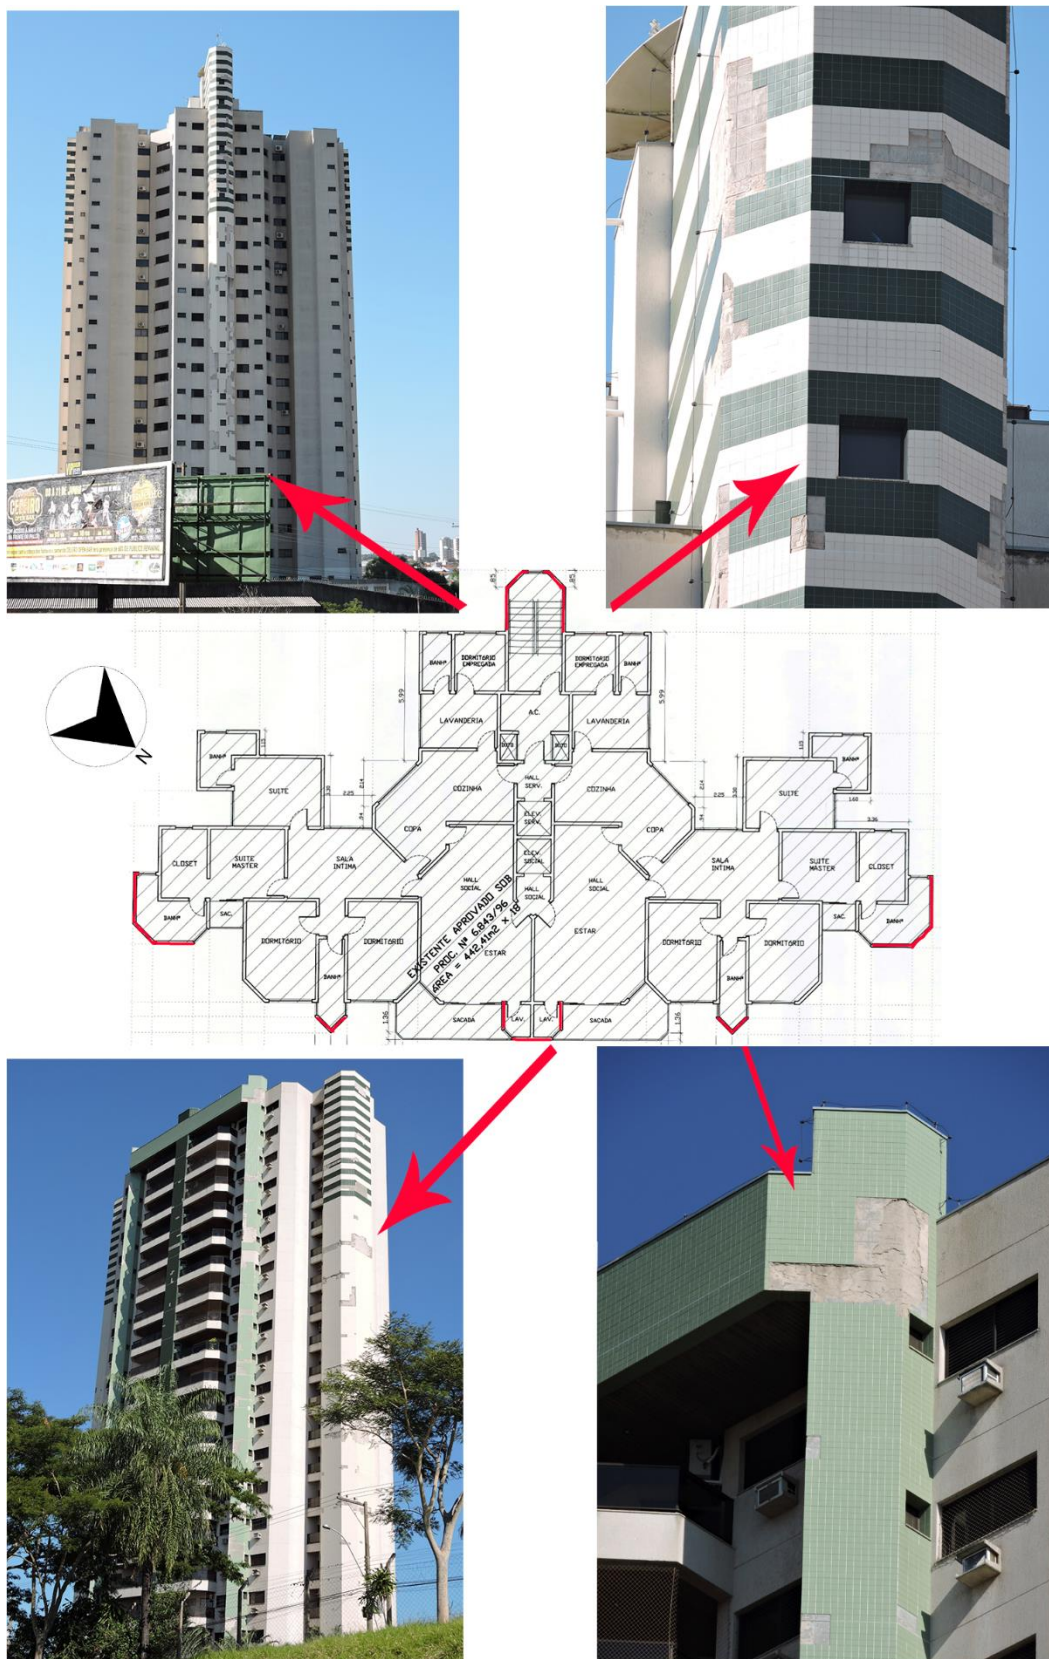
Planta baixa do pavimento tipo do Edifício 03 (sem escala).
